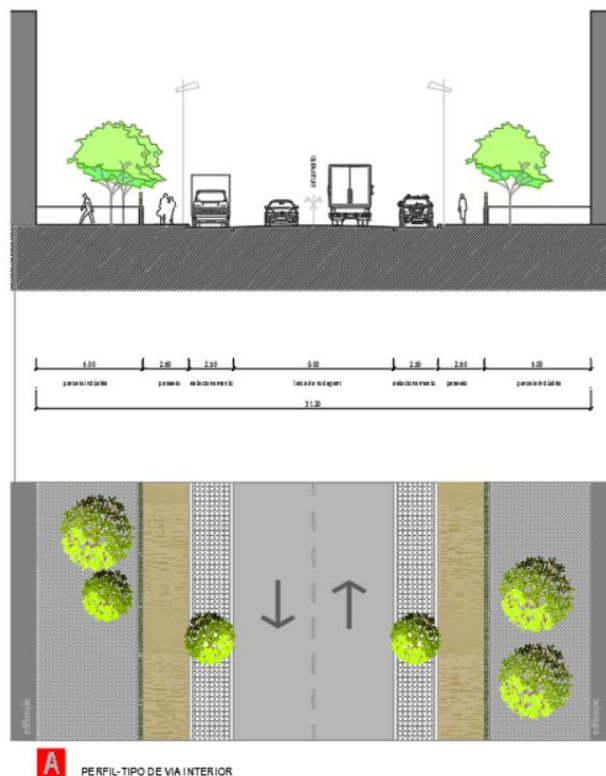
Perfil-Tipo de Av^a Calouste Gulbenkian, PPZIOH
